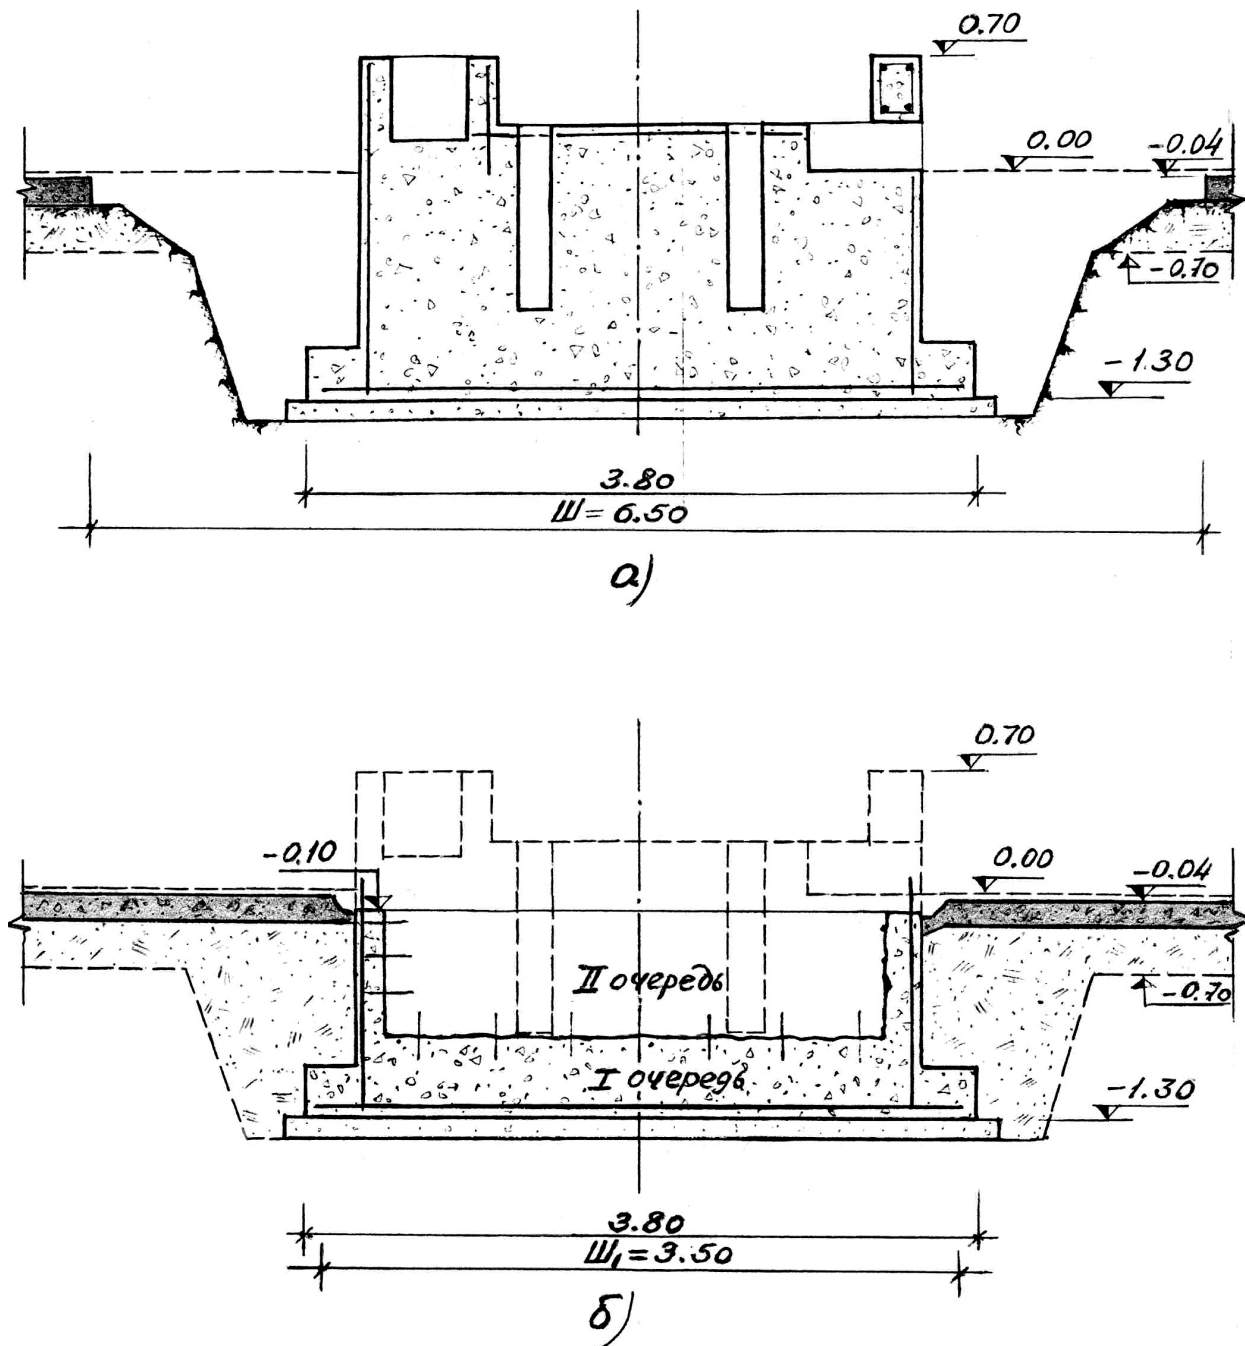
Пример устройства в две очереди опережающего фундамента под оборудование
